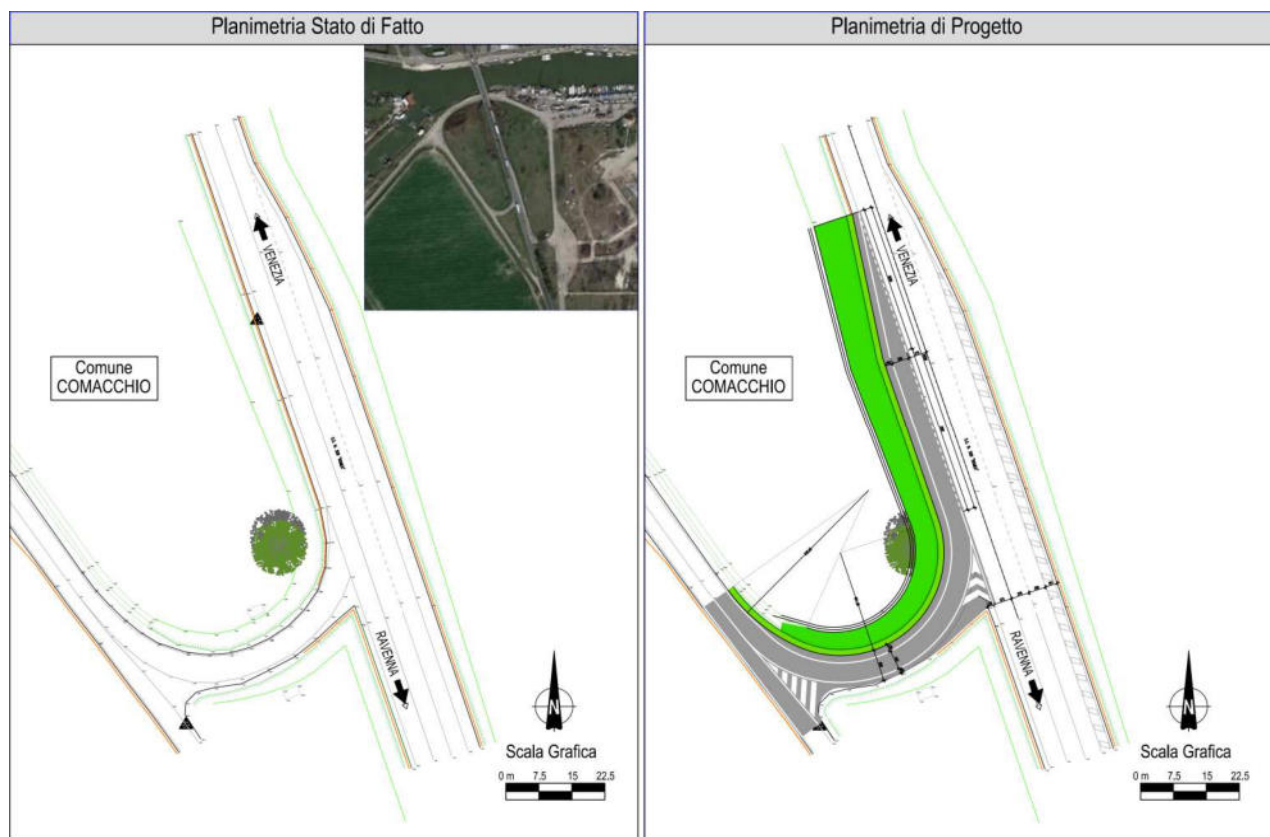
Intervento n. 6 – Planimetria Stato di Fatto e di Progetto
